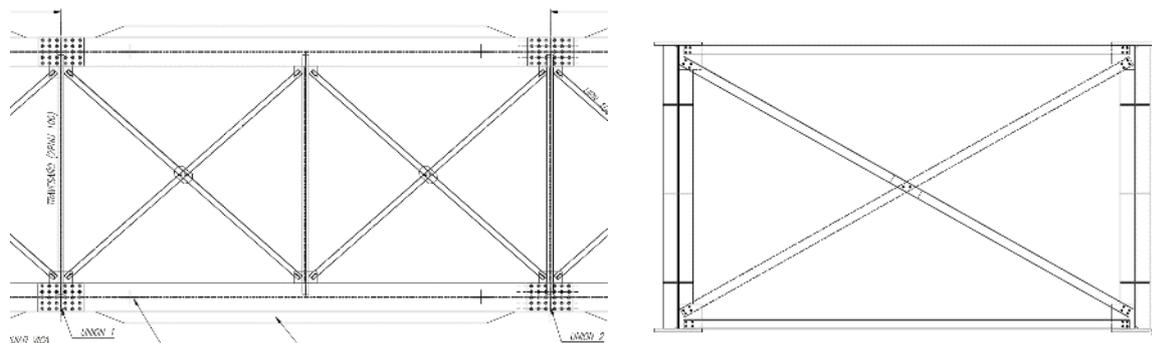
Esquemas de Arriostramiento horizontales y verticales de las vigas Armadas de alma llena.
